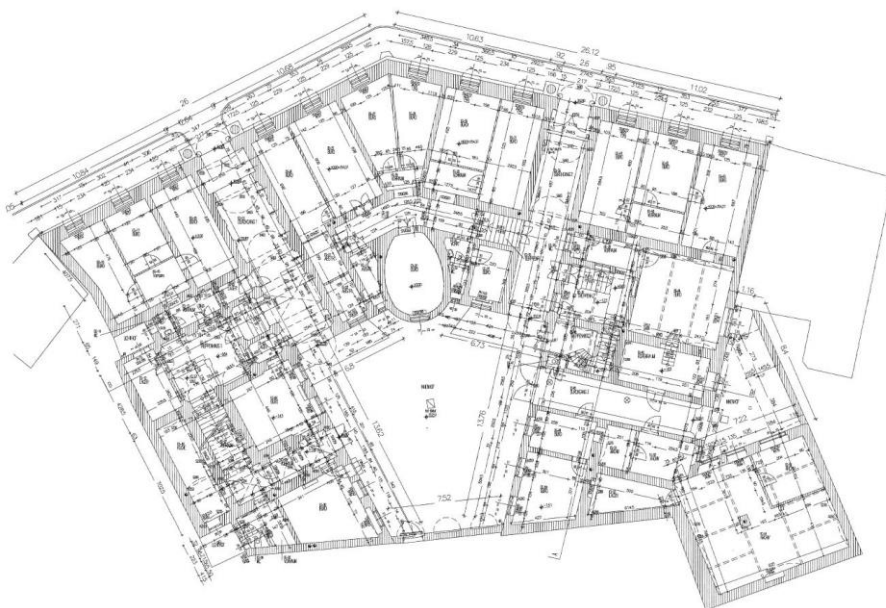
Opernring 7 - Grundriss Erdgeschoss
